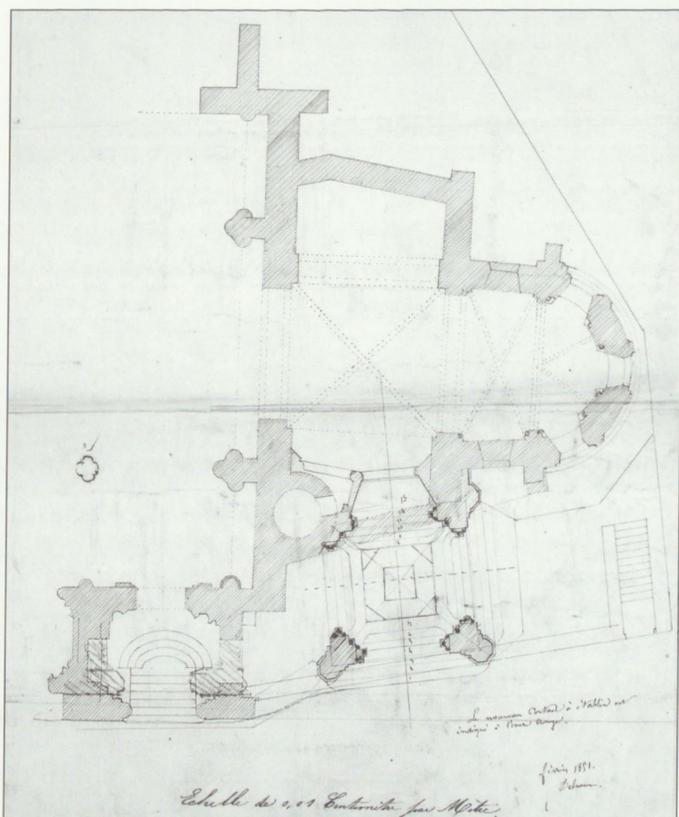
DELSAUX, J.-C., « Eglise Sainte-Croix à Liège. Plan d'un nouveau Portail à établir près de la tour », février 1851, 450 x 292 mm.
